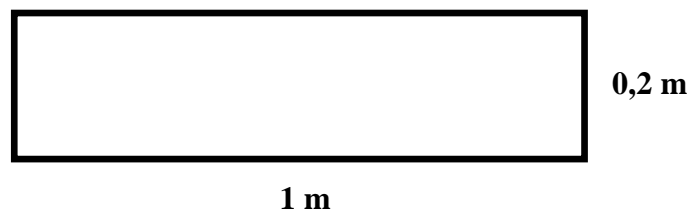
Section de calcul de la dalle pleine de sous sol 1 (parking)
